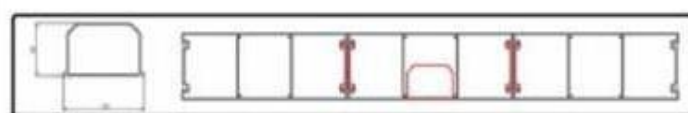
Esquema em planta do perfil canaleta dentro do módulo básico
